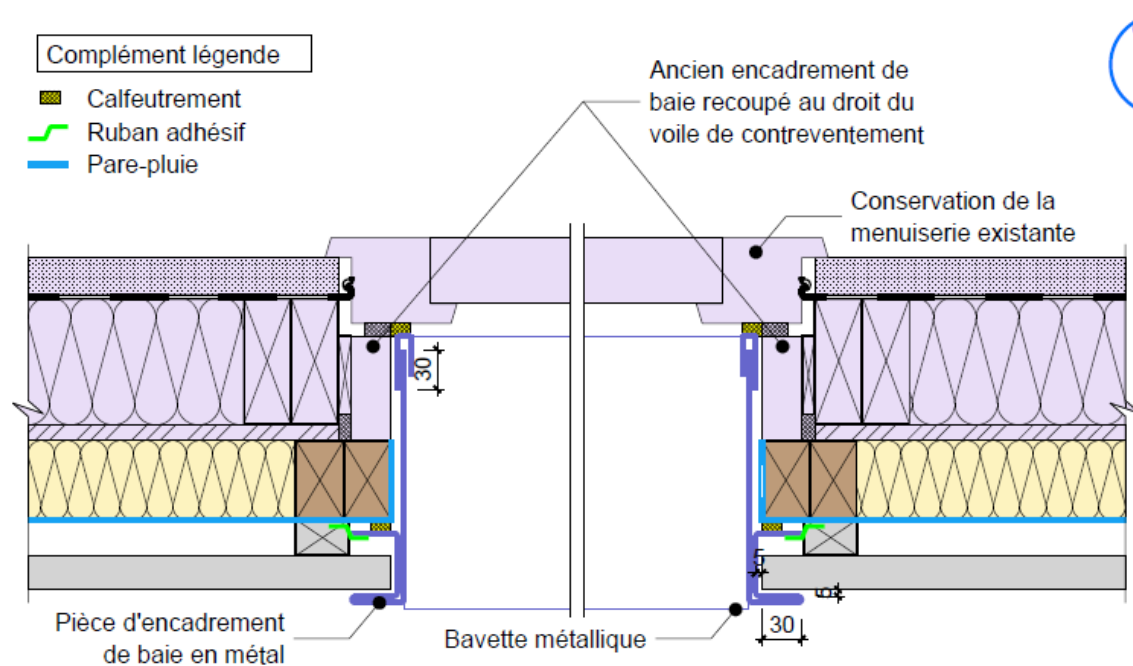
Baie avec encadrement rapporté en métal (coupe horizontale)
